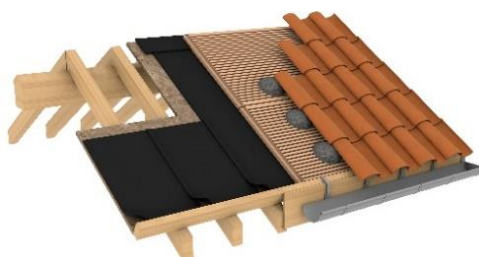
Esquema estrutural de cobertura inclinada.
